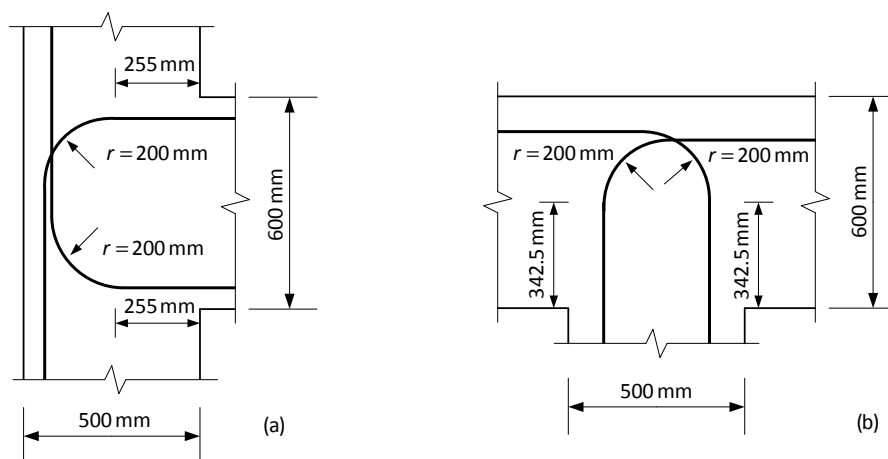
Geometria do eixo das armaduras longitudinais utilizada no modelo de comportamento da amarração, (a) ligações viga-pilar de extremidade e de cobertura exterior, (b) ligações viga-pilar de cobertura exterior e interior.
